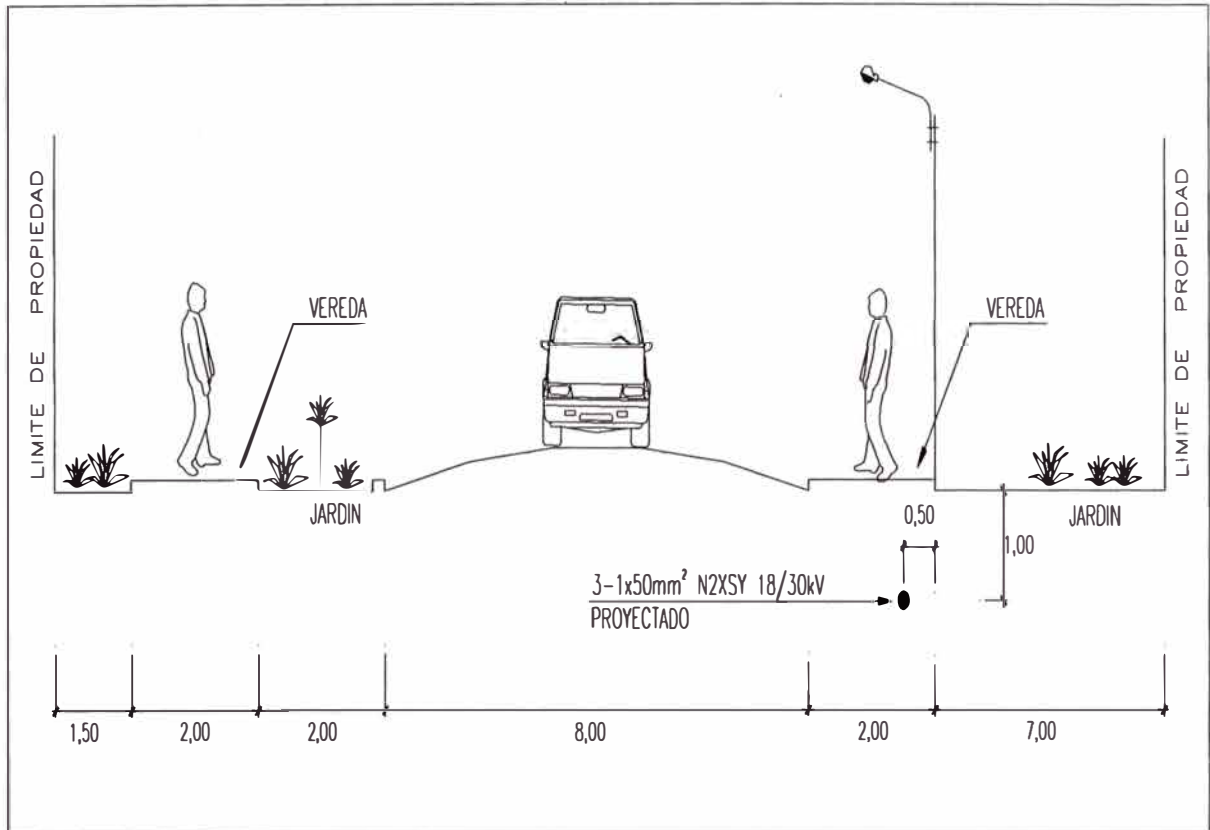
Detalle de instalación de cable bajo vereda (corte 1-1).
